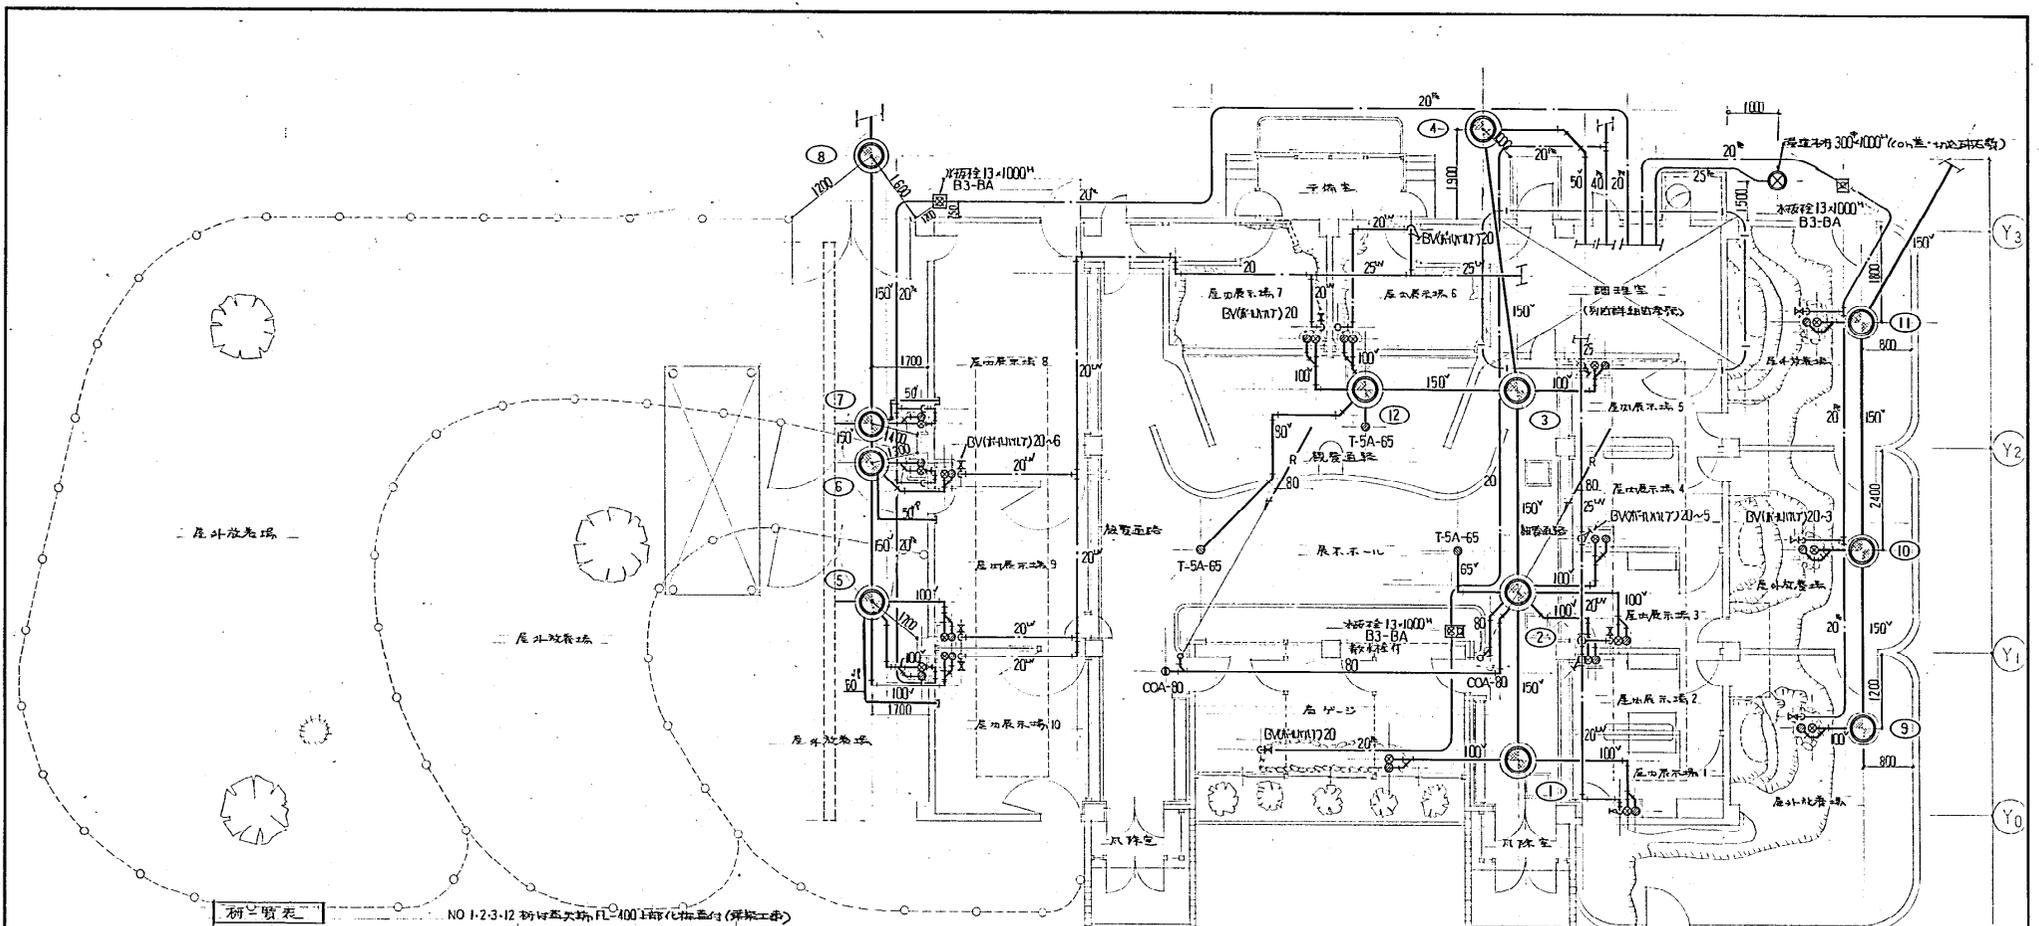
衛生排水設備図 (平面図) NO. 1-2-3-12 排水設備図 (FL=100) 1階 (別館併設)
